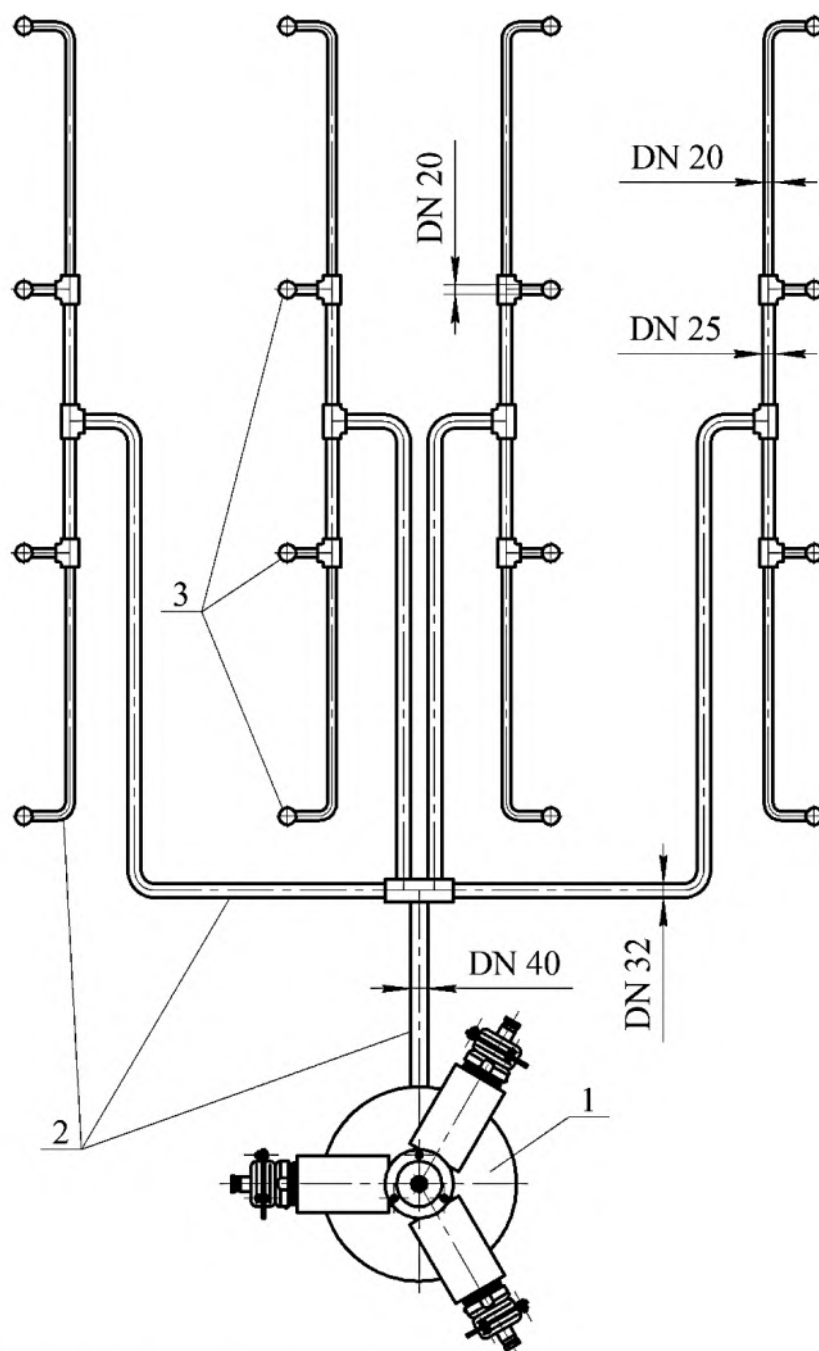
Вариант трубной разводки для 16-ти насадков-распылителей
